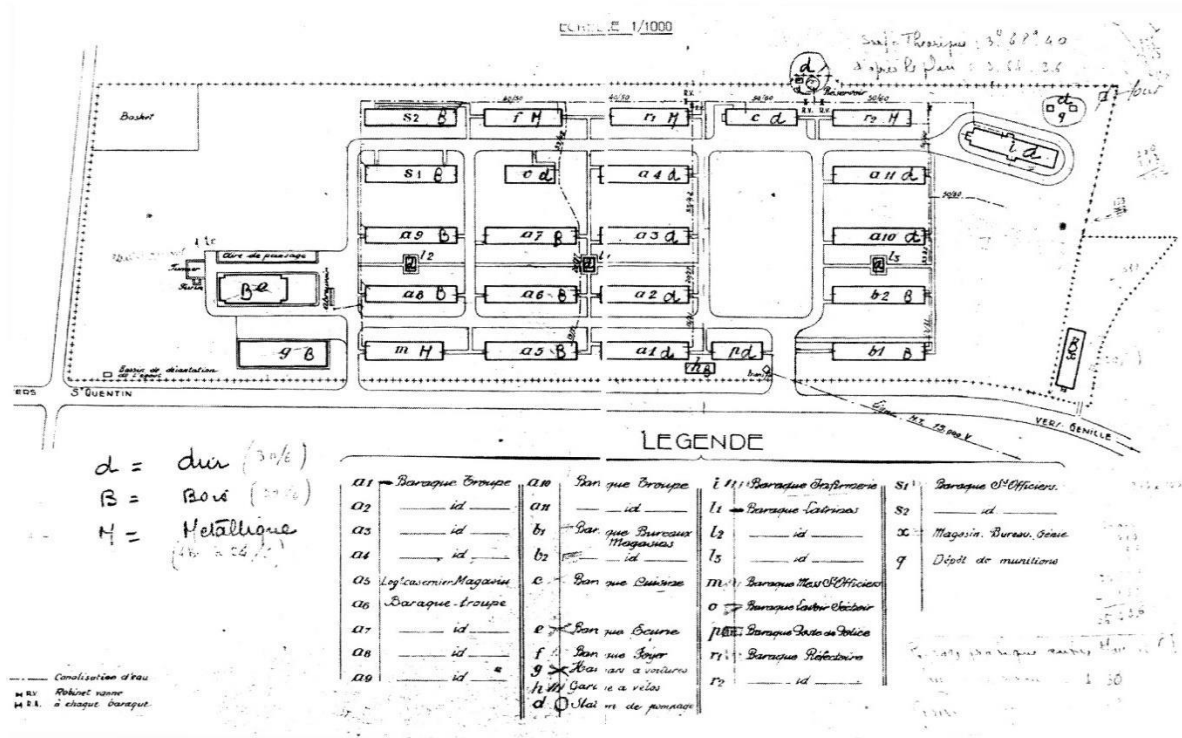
Plan de disposition des baraquements du camp militaire du Rassay (Source : étude d'impact)
